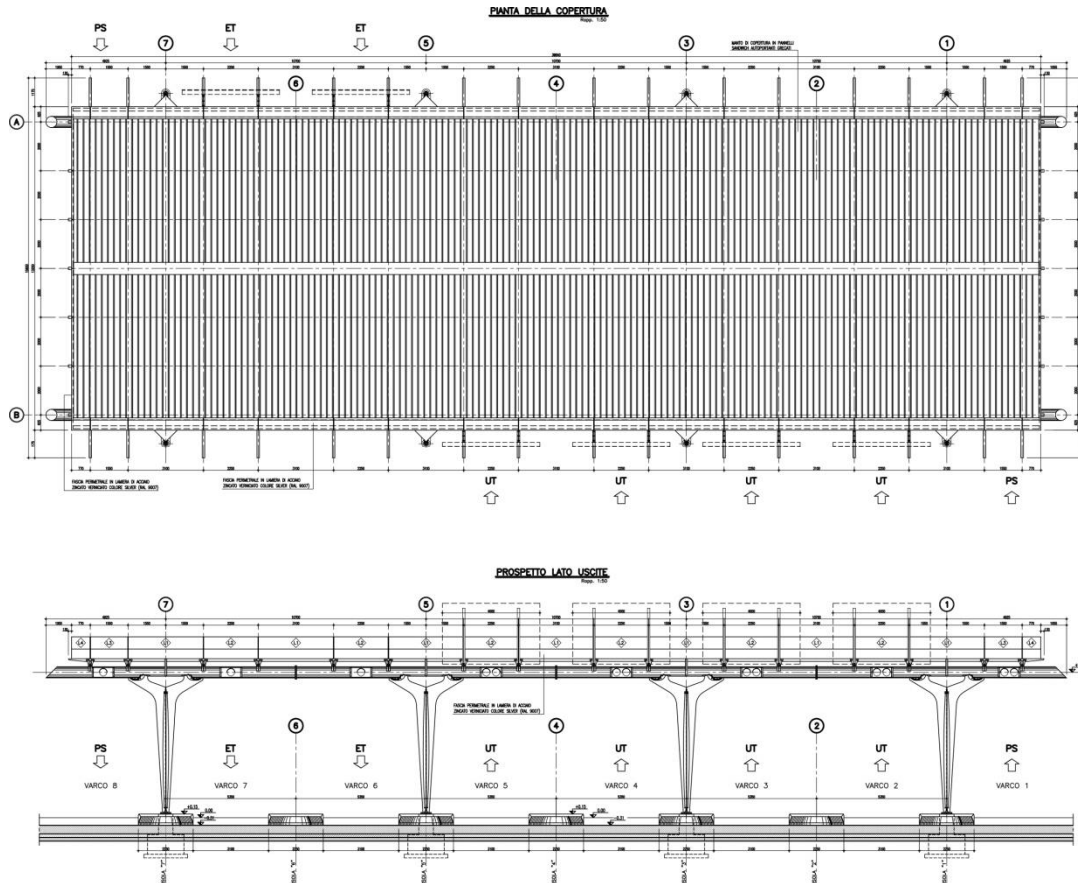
È Pensilina di stazione - Pianta e prospetto
